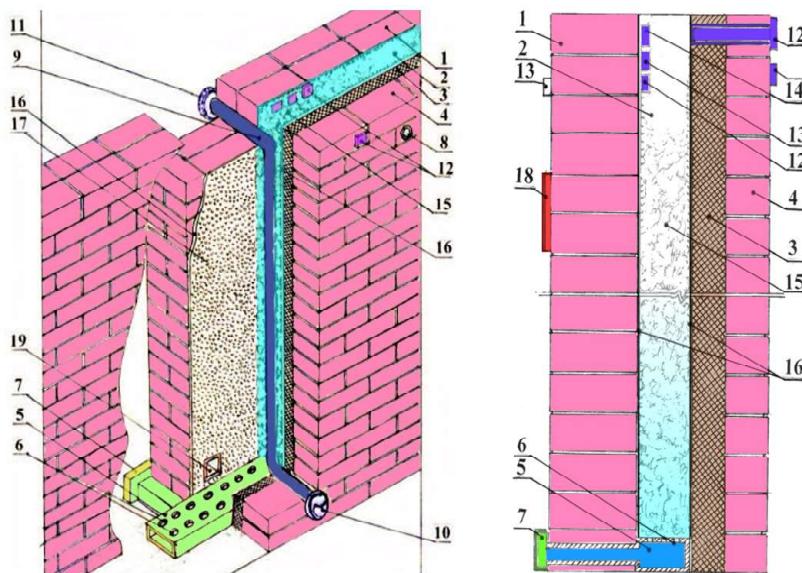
Общая схема конструктивного решения энергосберегающей стены с регулируемыми теплозащитными свойствами и ее вертикальный разрез: 1 – стена из традиционных стеновых материалов (монолитный бетон, кирпич, блоки из ячеистого бетона и т. п.); 2 – внутренняя воздушная прослойка; 3 – слой эффективного утеплителя, например из минеральной ваты; 4 – защитный наружный слой стены; 5 – перфорированный трубопровод; 6 – отверстия; 7 – устройство для подогрева и подачи теплого воздуха (воздушно-тепловые завесы, тепловентиляторы и т. п.); 8 – клапан для выпуска отработанного воздуха; 9 – воздуховод различной формы для подачи свежего воздуха; 10 – заборный клапан; 11 – приточный клапан; 12 – датчик температуры; 13 – датчик влажности; 14 – датчик плотности; 15 – натуральный или искусственный пух из расчета 1,2-3,6 килограмма на 1 м³ объема воздушной прослойки; 16 – вертикальные слои с выступающими элементами в виде крючков; 17 – крючки различной формы (наподобие одной из поверхностей застежек-липучек); 18 – блок автоматизированного управления теплозащитными свойствами стены и воздухообменом; 19 – отверстие с клапаном для наполнения воздушной прослойки пухом и замены пуха после заданного срока эксплуатации.
